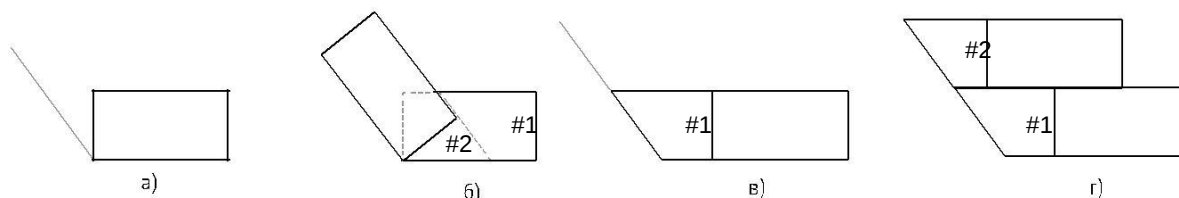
Разрезка и укладка теплоизоляционных плит в тупых углах кровли
